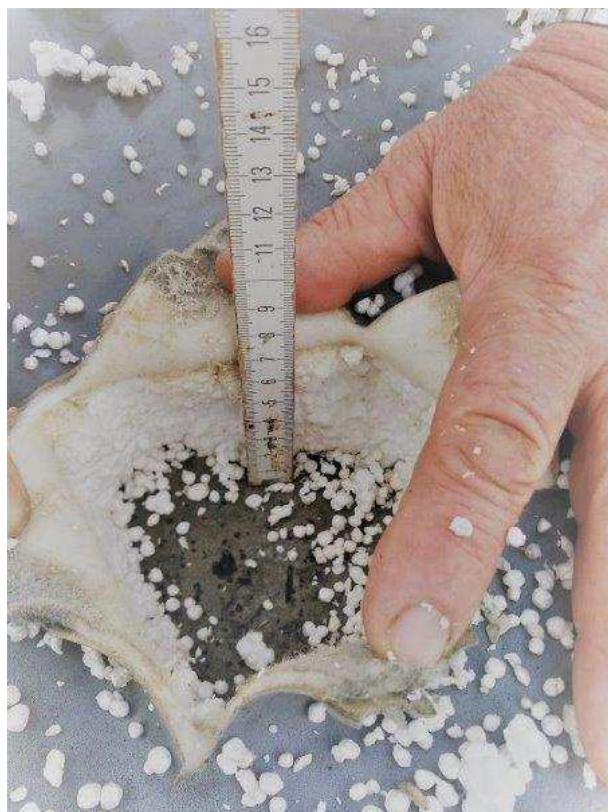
sonda č. 1 provedená objednatelem na střeše B
